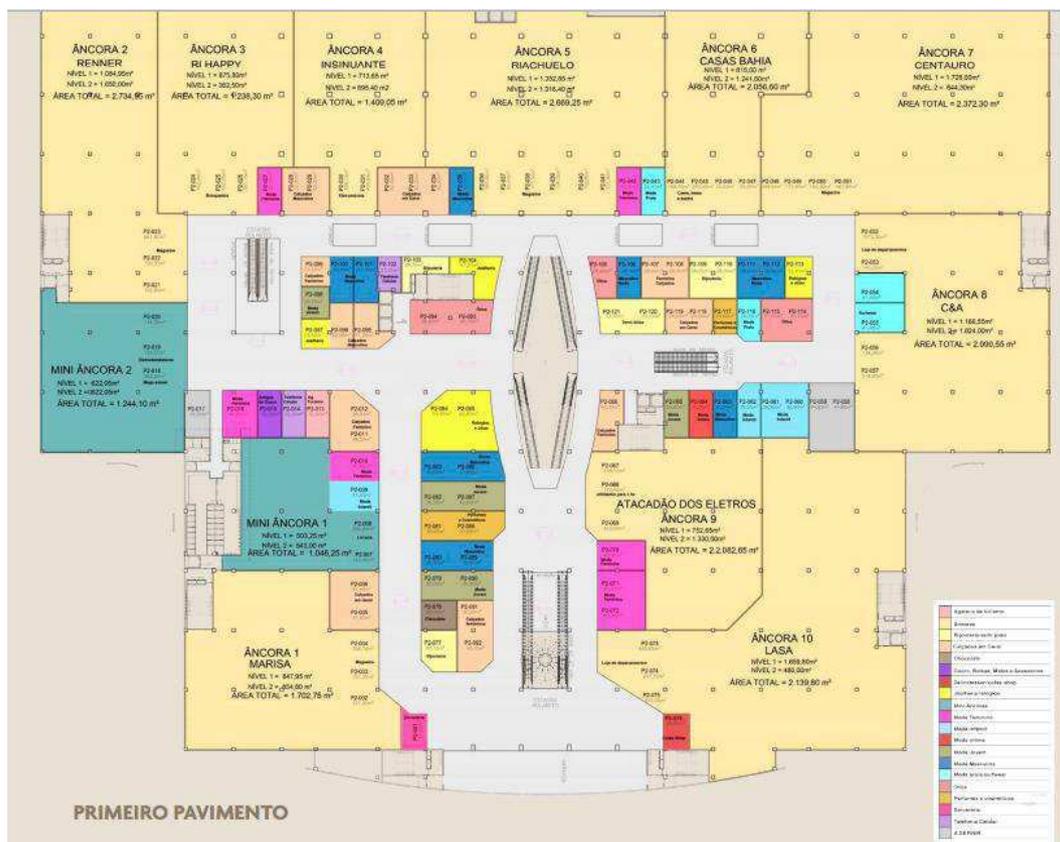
PLANTA BAIXA DO 1º PAVIMENTO.
